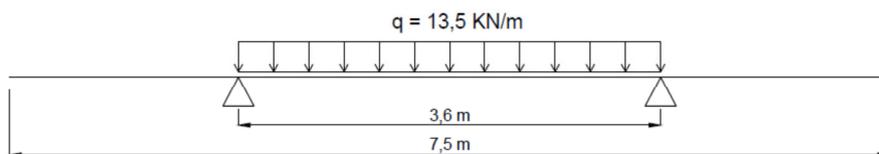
Viga teórica para el cálculo de las vigas transversales apoyadas sobre los pilotes. Momento flector máximo
